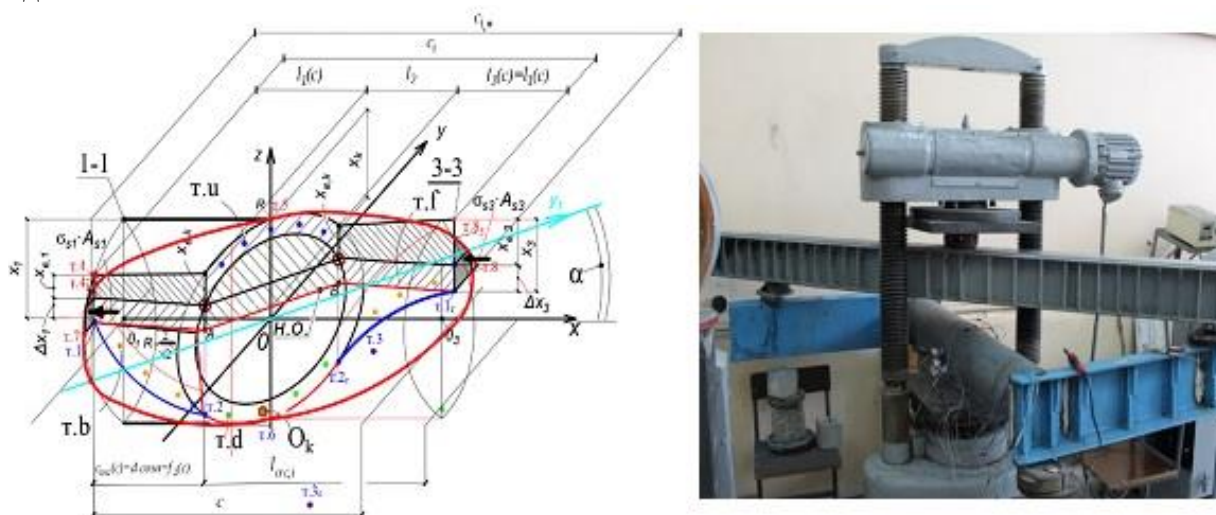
Разработка расчетной модели сложного сопротивления железобетонных конструкций круглого и прямоугольного сечения
